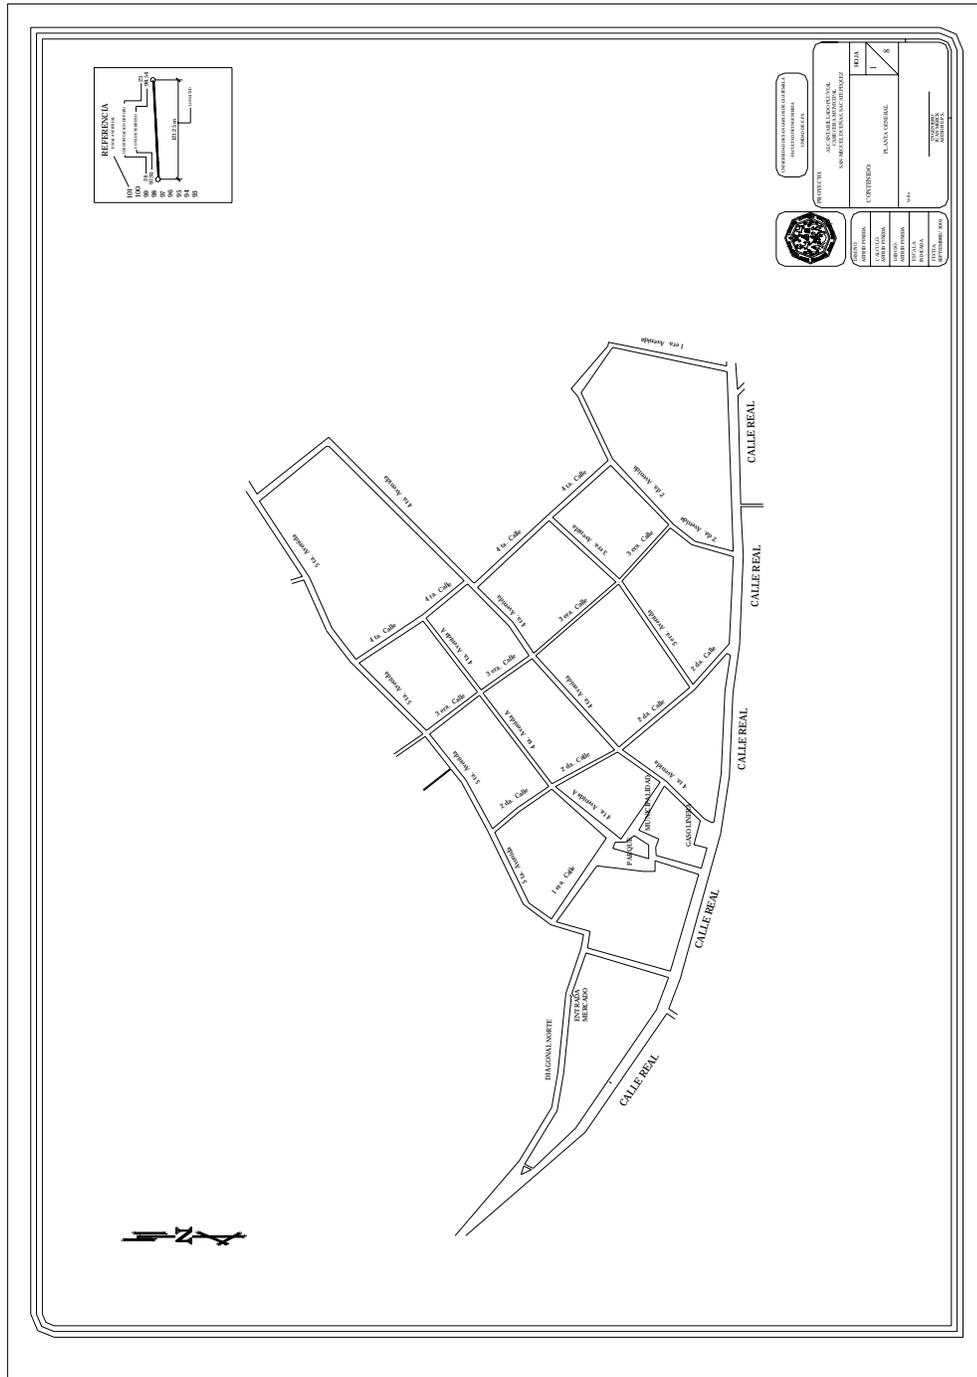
Planta y perfiles fase tres "a" alcantarillado pluvial
